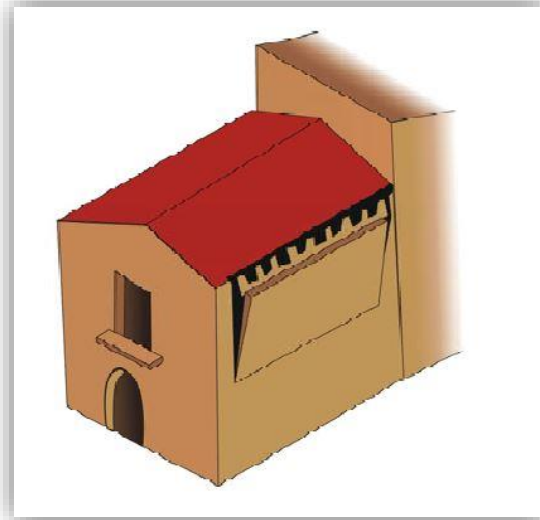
Rupture hors plan du mur due à la poussée de la toiture.
